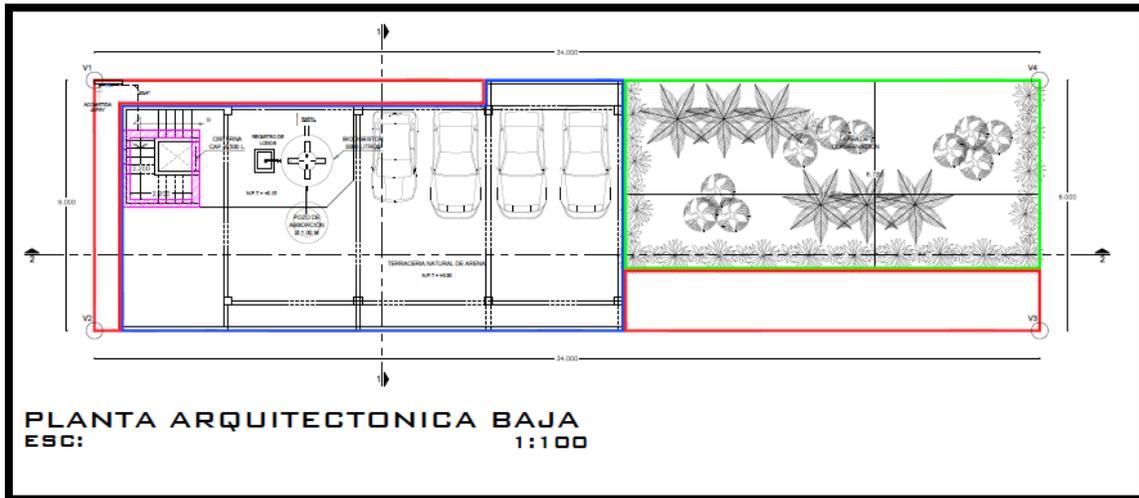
Superficies del proyecto en planta baja (ver plano en el anexo 1).
